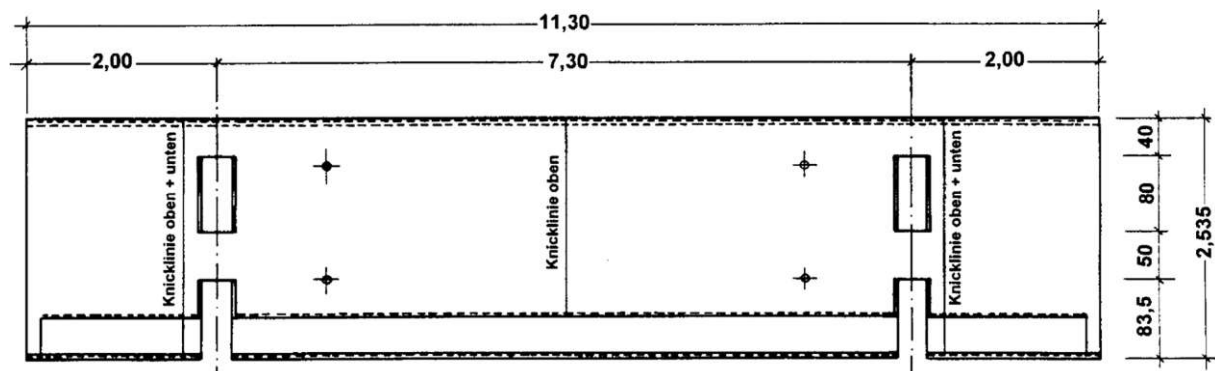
Vollfertigteil – Grundriss. Bildquelle: [26]
